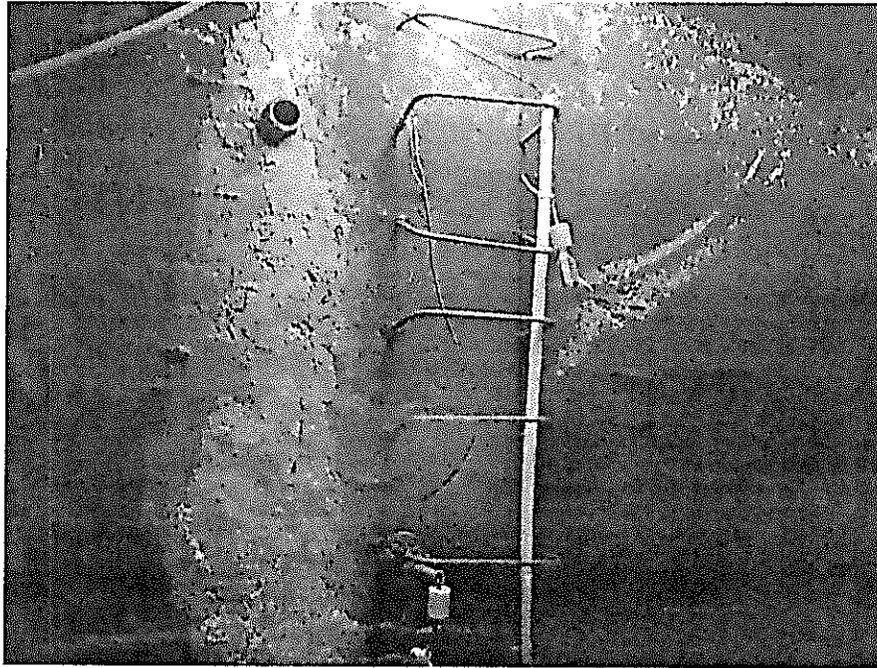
Re parcheo sobre fisura en muro, escaleras en barras de 3/8" en mal estado. "fuente propia".
